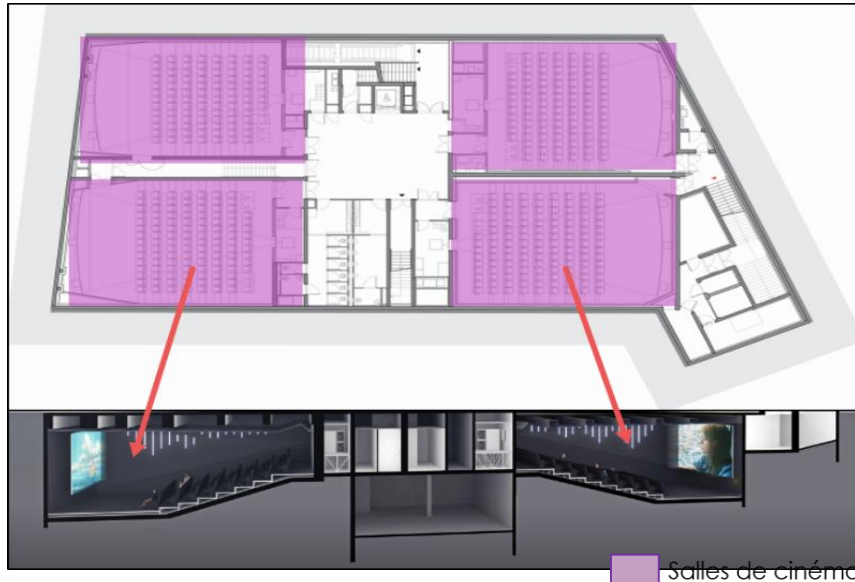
Plan et coupe sur le sous-sol du cinéma Alesia, source : Manuelle Gautrand architecture, cinéma Alesia, Paris, 2007.PDF
